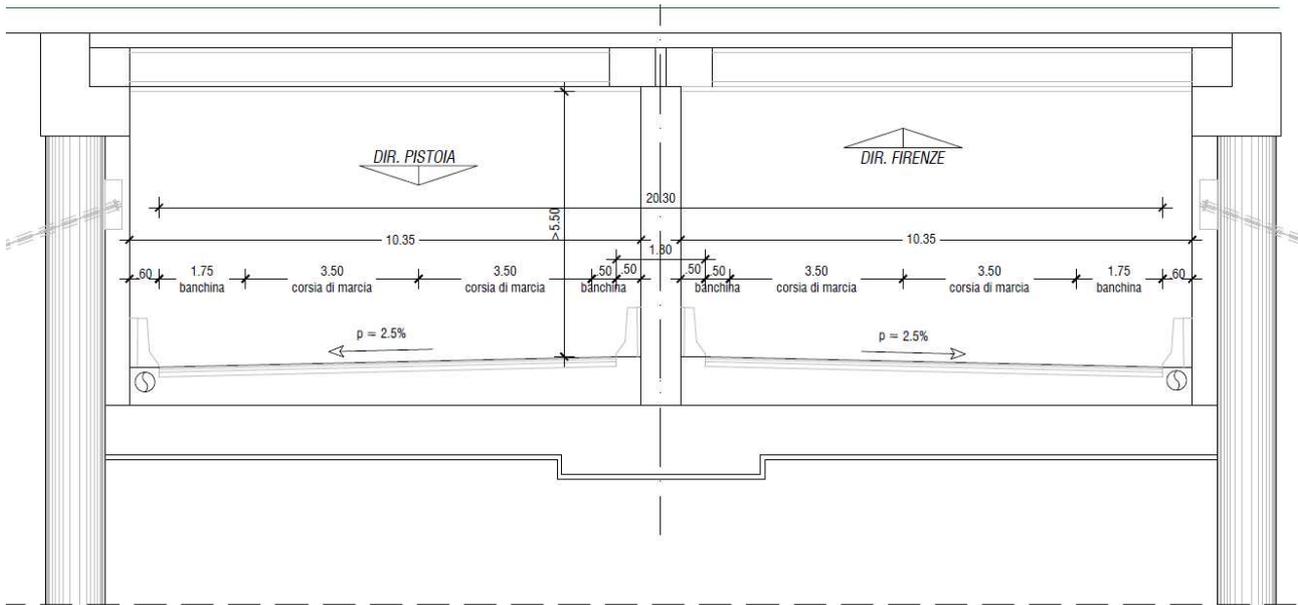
Sezione tipo "ASSE PRINCIPALE"
